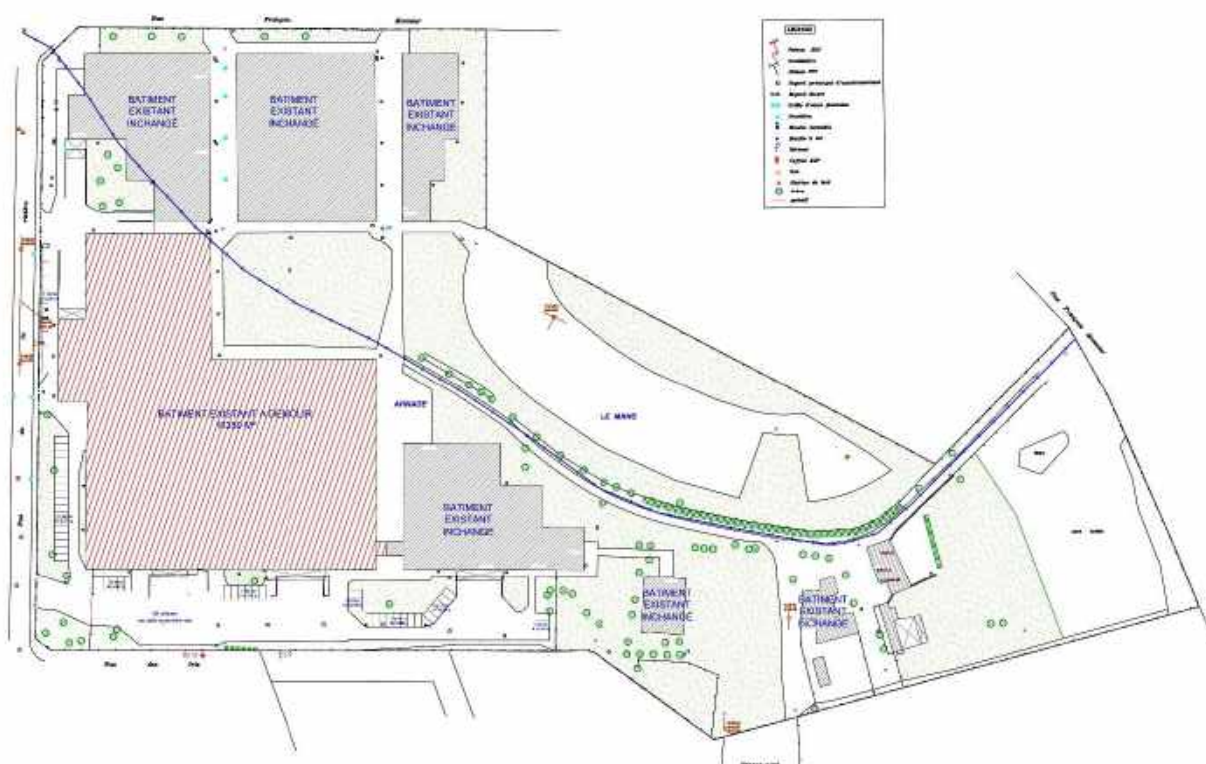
Plan masse du site (Source : Cabinet Barbier)
